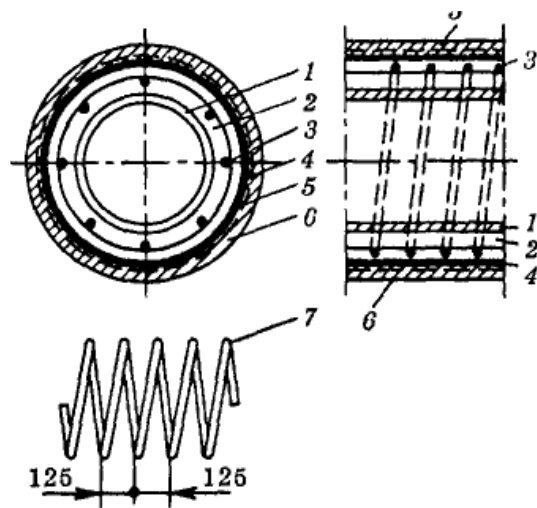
Конструкция монолитной армопенобетонной изоляционной оболочки
